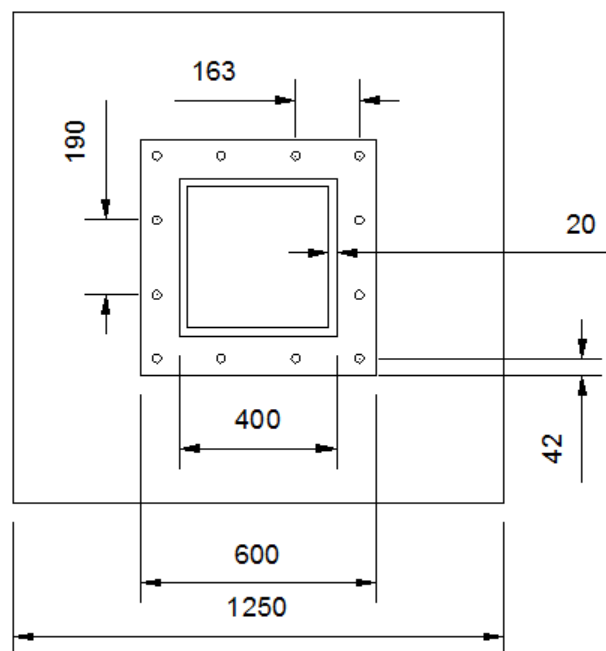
Vista en planta conexión columna tubular rectangular compuesta a cimentación con placa base emperrada. Conexión 3. (Dimensiones en *mm*)
